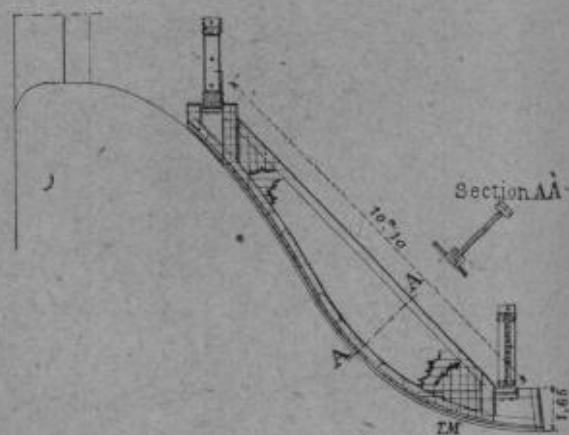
Usine de Keokuk. — Moules pour le déversoir.
